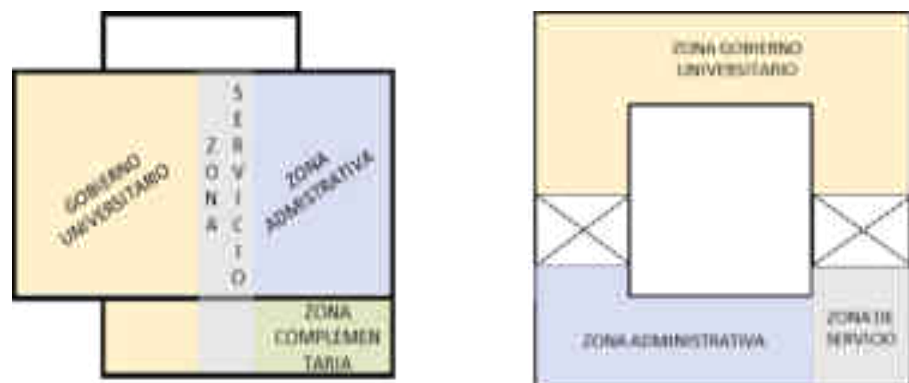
Esquema de zonificación en planta y corte – Elaboración Propia
